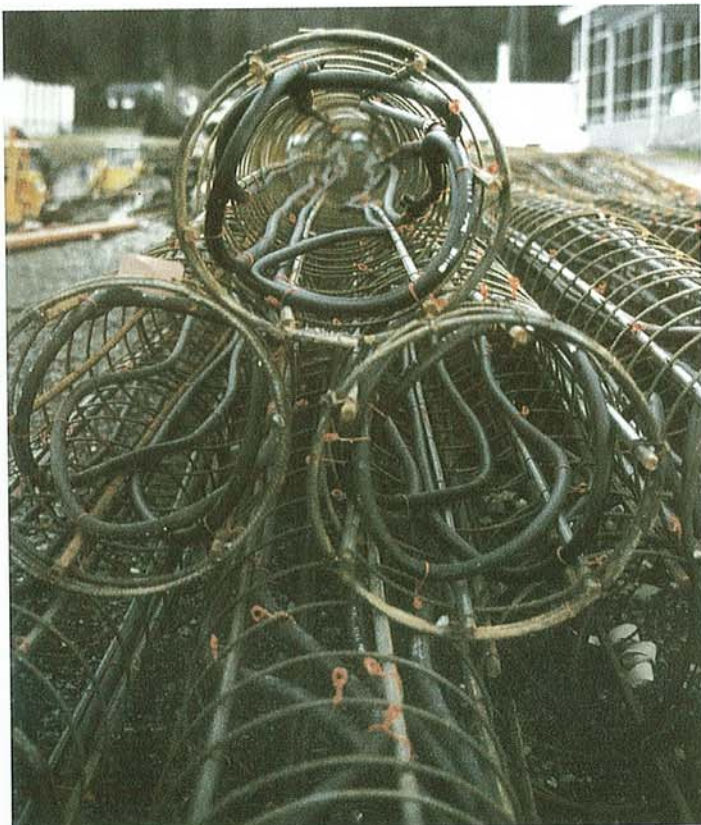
Bewehrungskörbe mit HDPE-Wärmetauscherrohren, einbaufertig an der Baustelle Medienhaus Vorarlberg, Schwarzach (Februar 1995)
